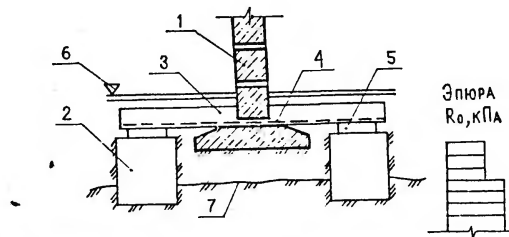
Подведение новых элементов без ослабления фундаментной стены
